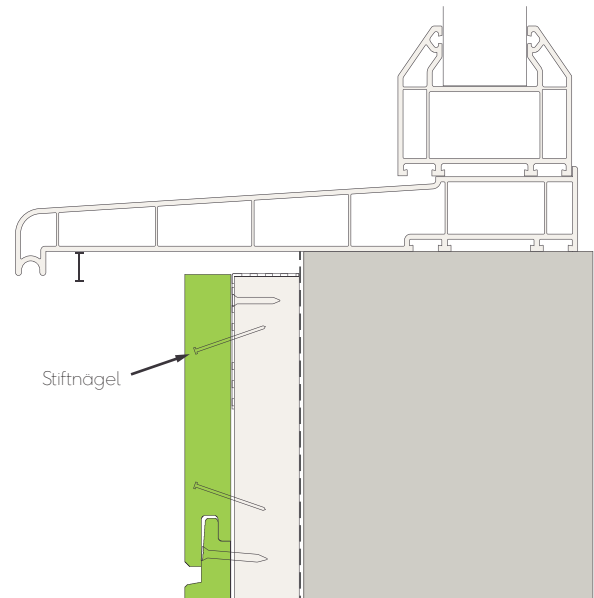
Detail Fenster/Türschwelleverbindung - Stiftnägel
